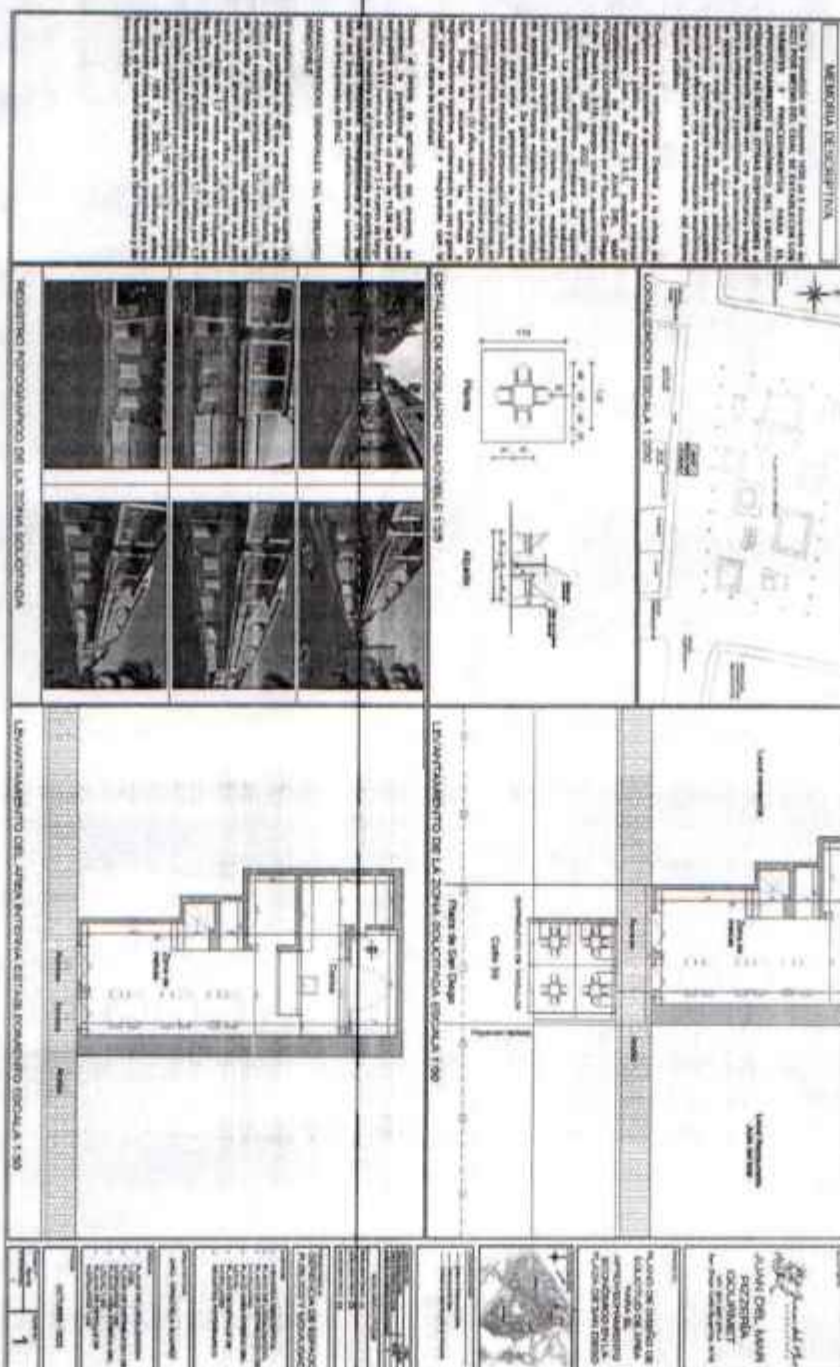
Plano JUAN DEL MAR PIZZERÍA
